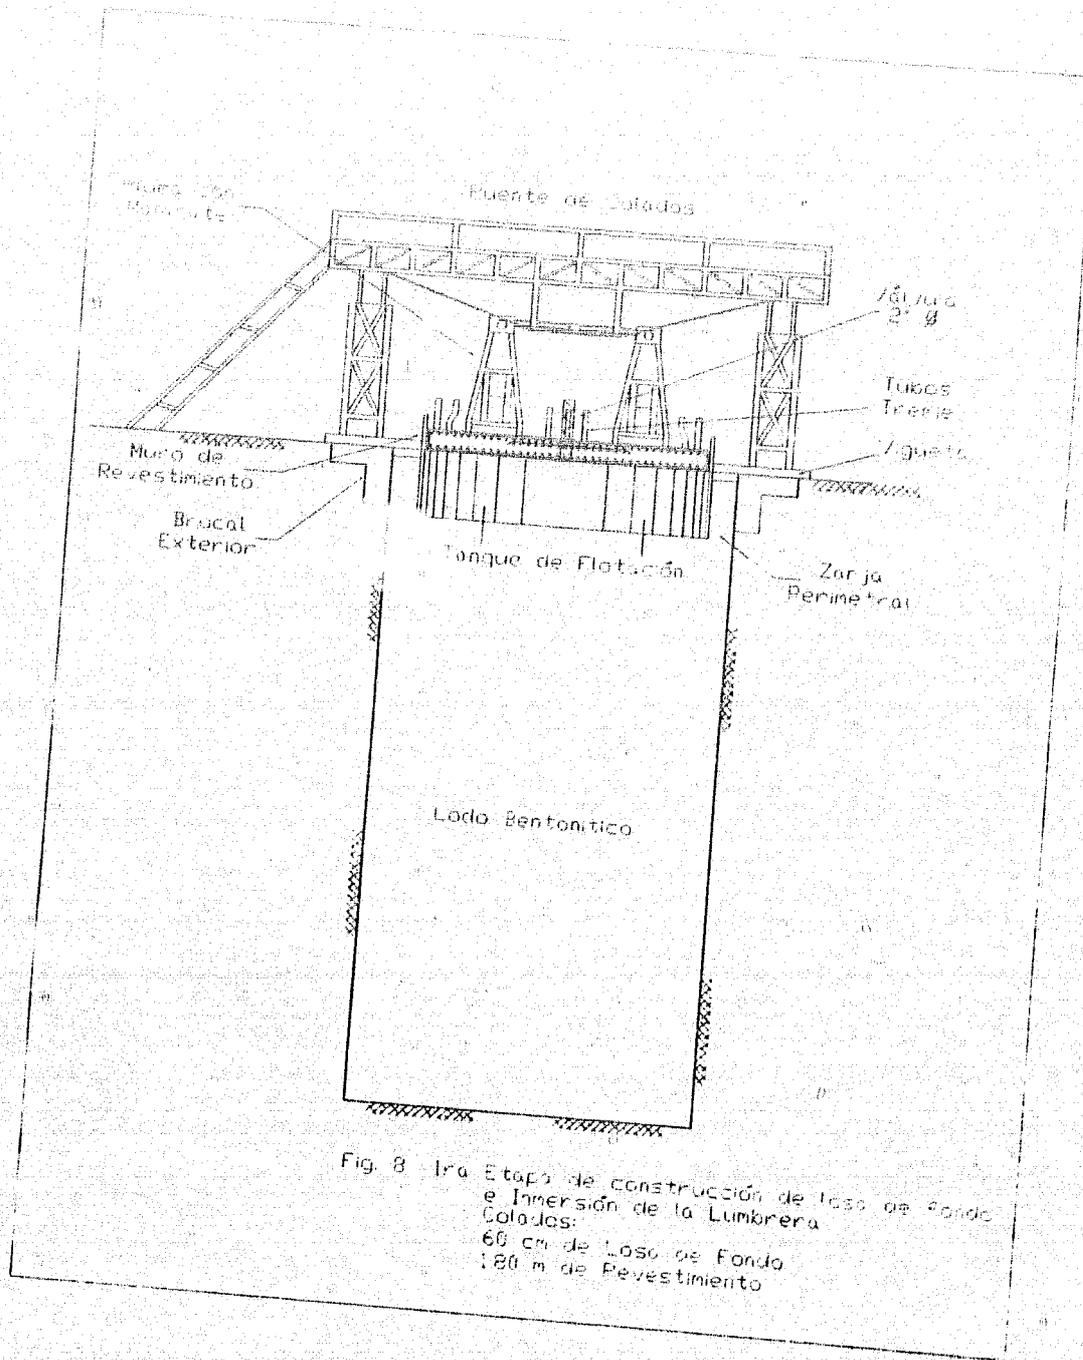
1ra Etapa de construcción de losa de fondo e Inmersión de la Lumbrena Coladas:
